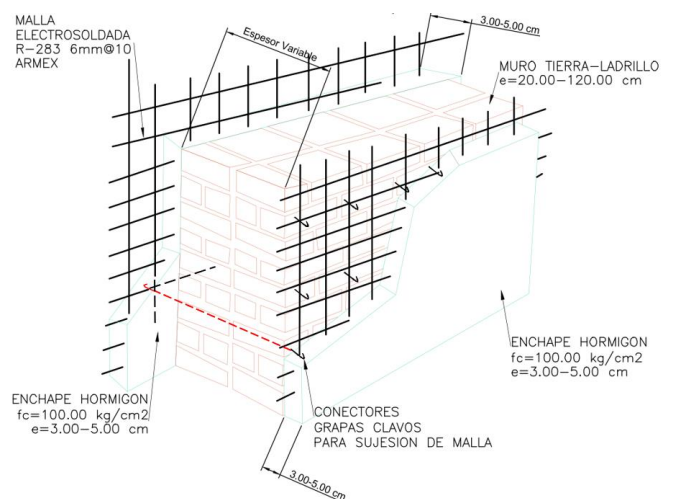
Detalle de Enchape de malla electrosoldada, para muro de adobe
